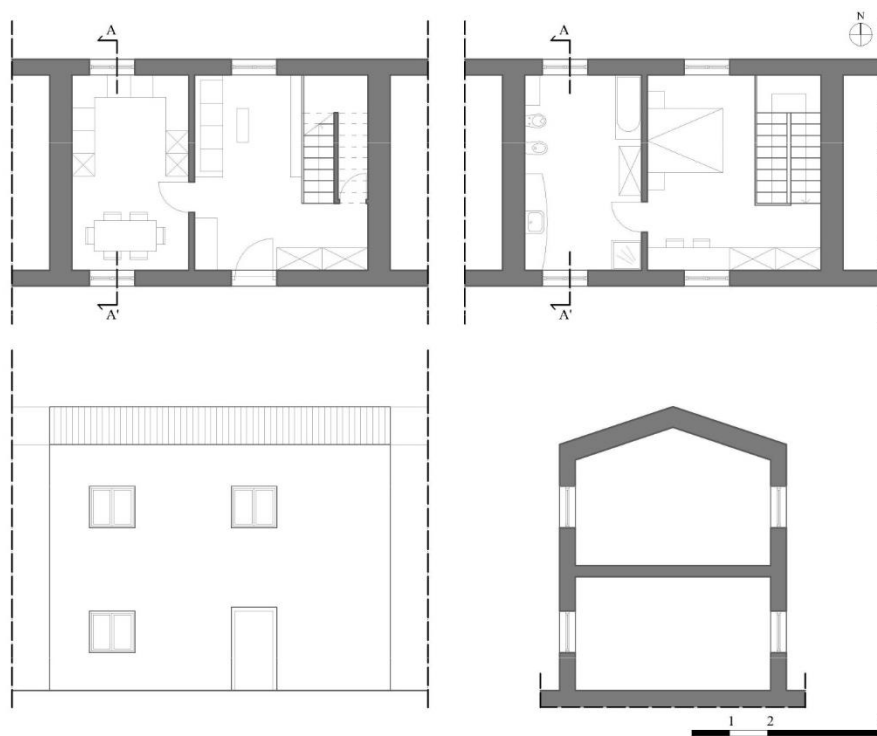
Planimetrie, prospetto e sezione dell'edificio di progetto
